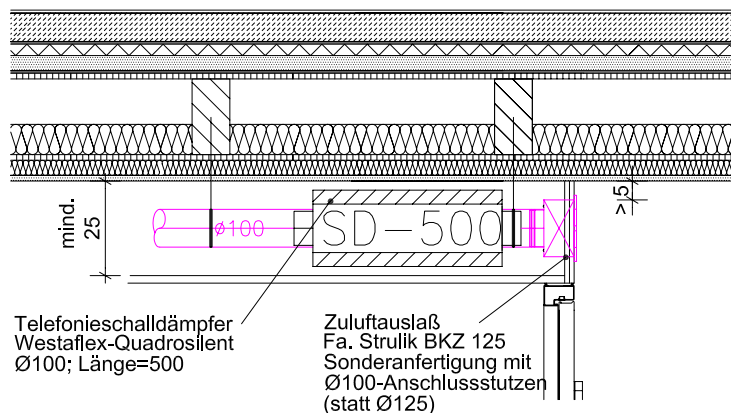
DETAIL ZULUFTDURCHLASS AUS ABGEHÄNGTER DECKE
